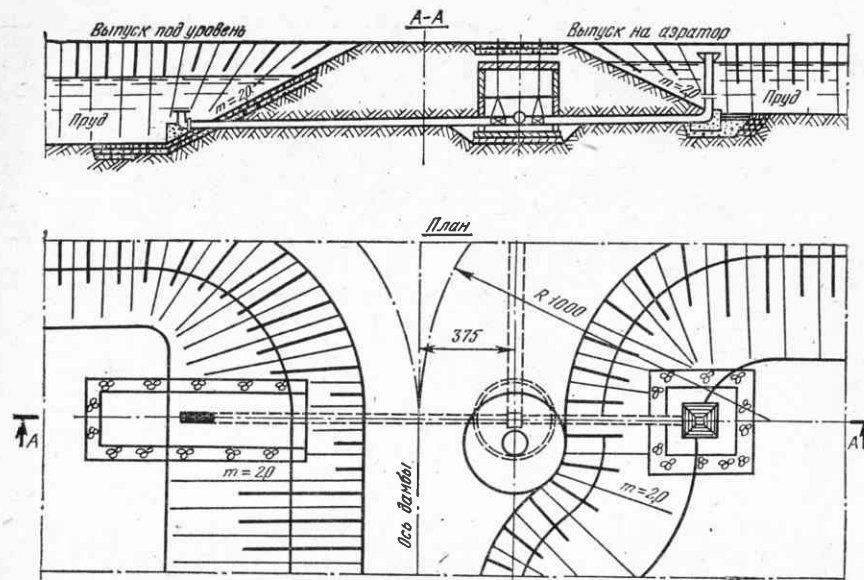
Водовыпуск из напорного трубопровода в два зимовальных пруда на расход до 0,1 м³/с (типовой проект 820-63/74 Киевского отделения Гидрорыбпроекта)
